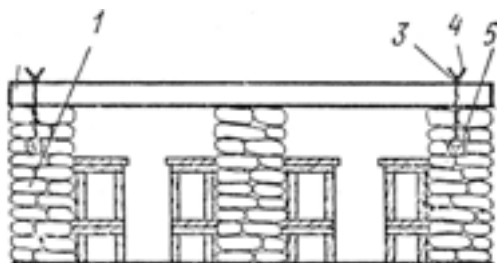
Поперечный разрез убежища со стенами из грунтонабивных мешков: 1 – стена; 2 – железобетонная плита покрытия; 3 – продольный арматурный стержень; 4 – проволочные скрутки; 5 – продольный деревянный брус
